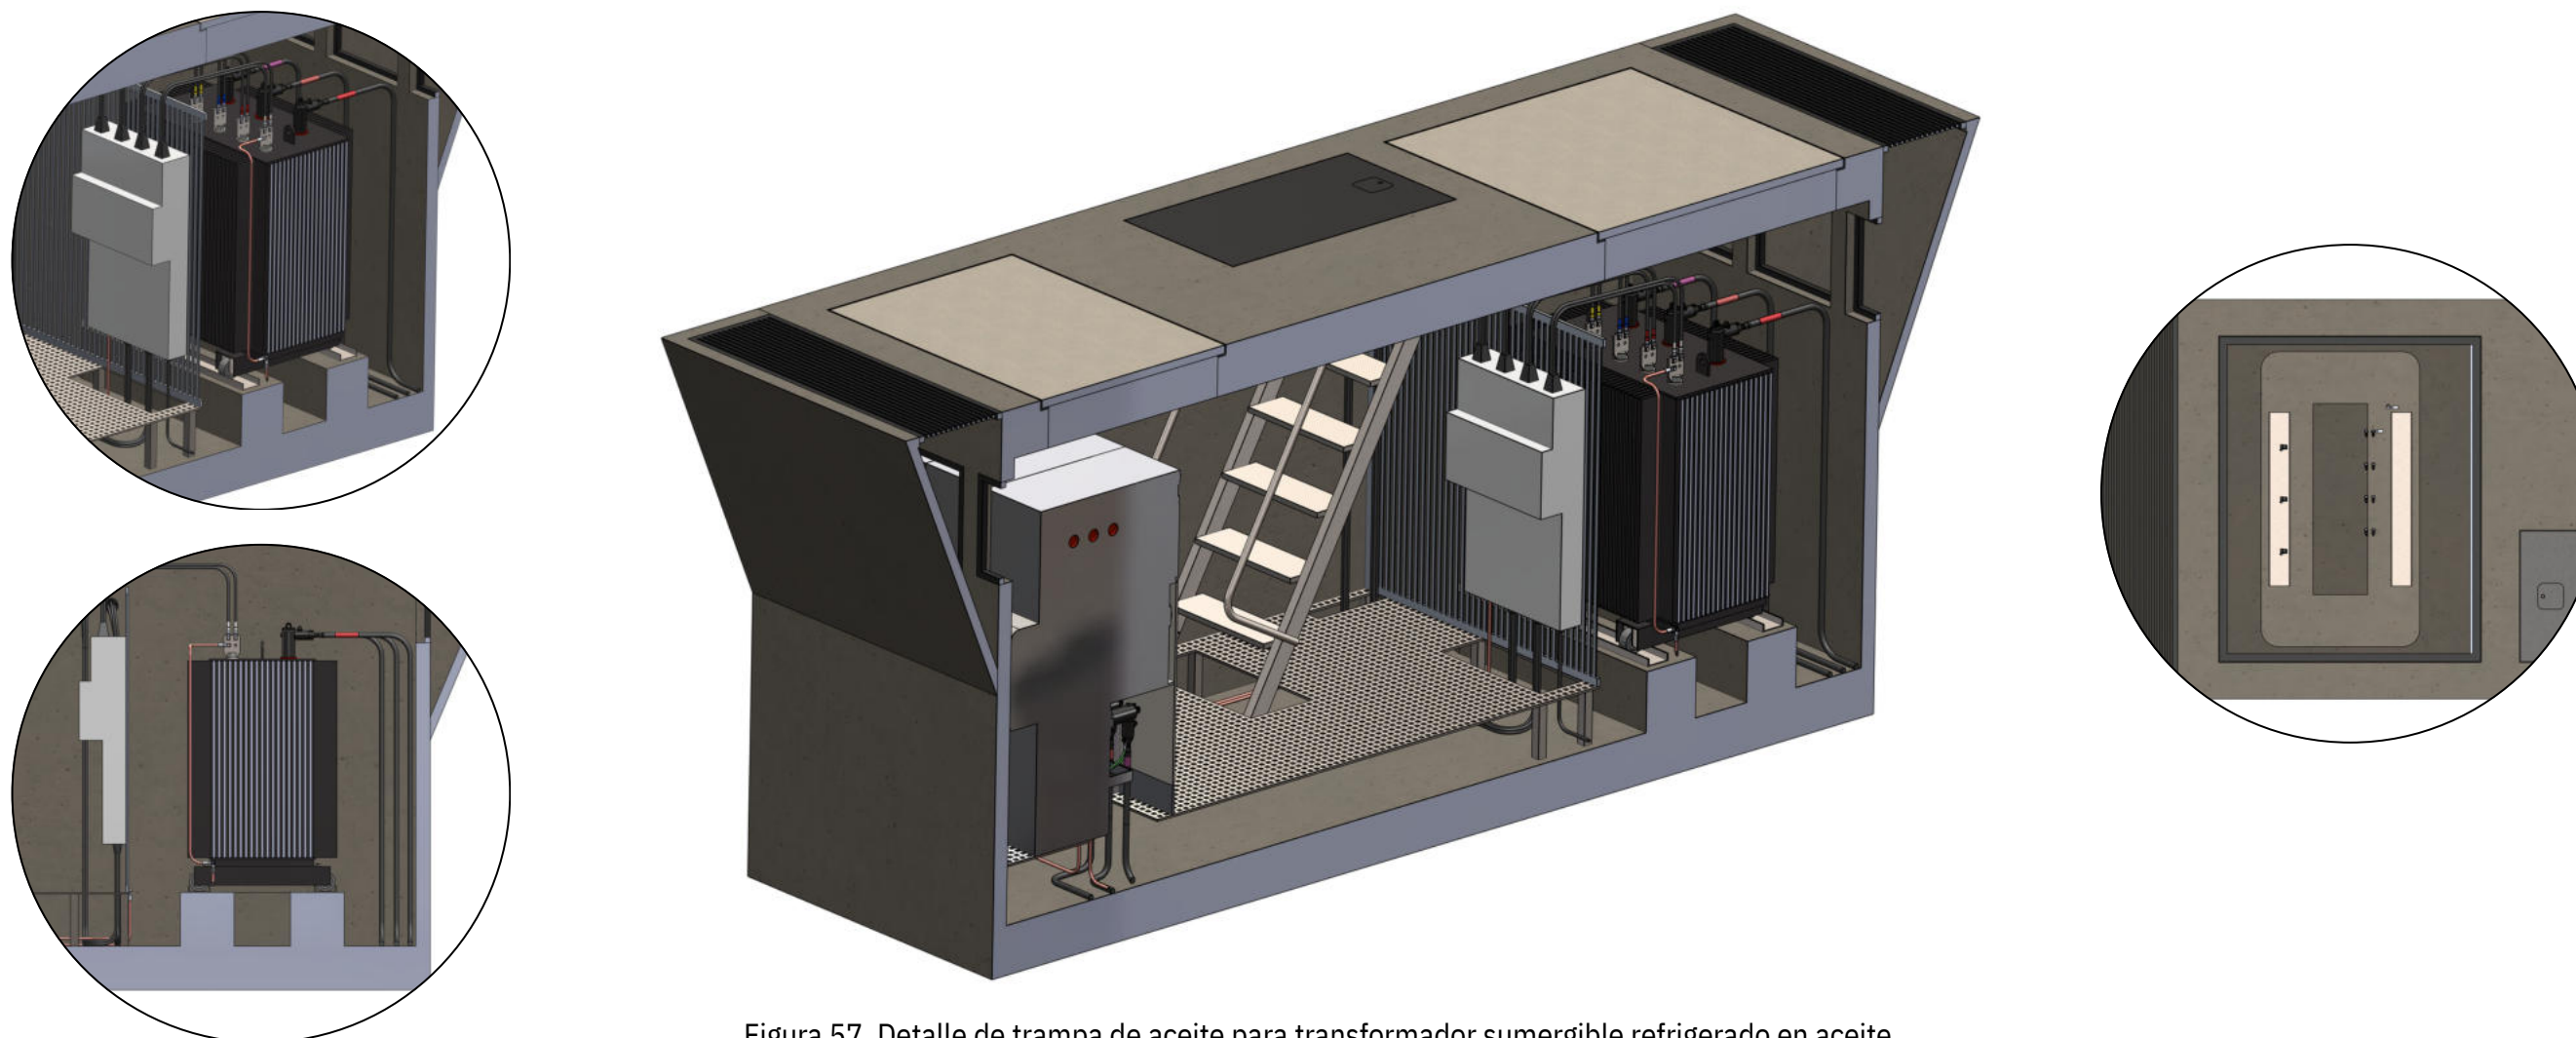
Detalle de trampa de aceite para transformador sumergible refrigerado en aceite
